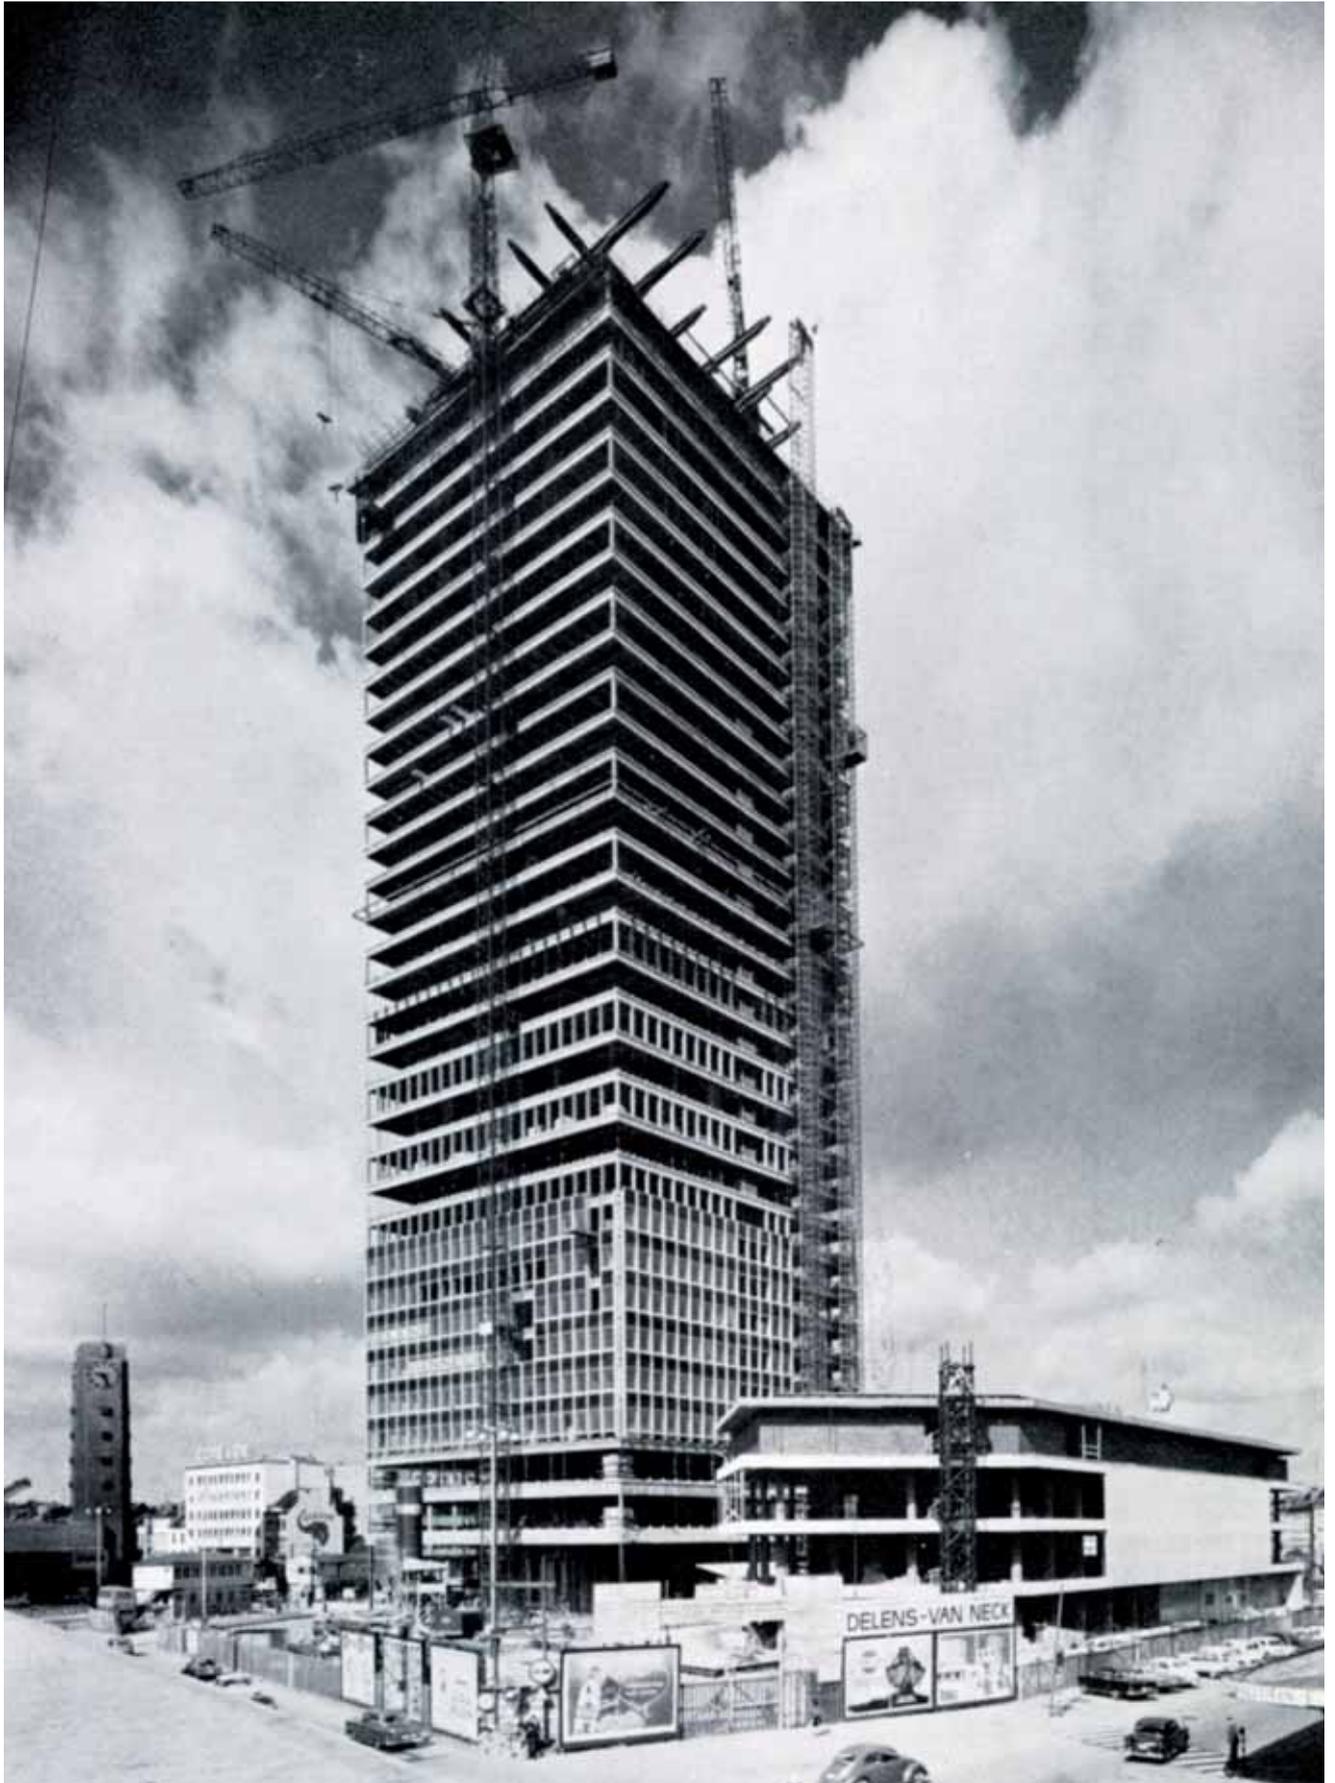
Construction de la Tour du Midi avec des poutres PREFLEX [10].
